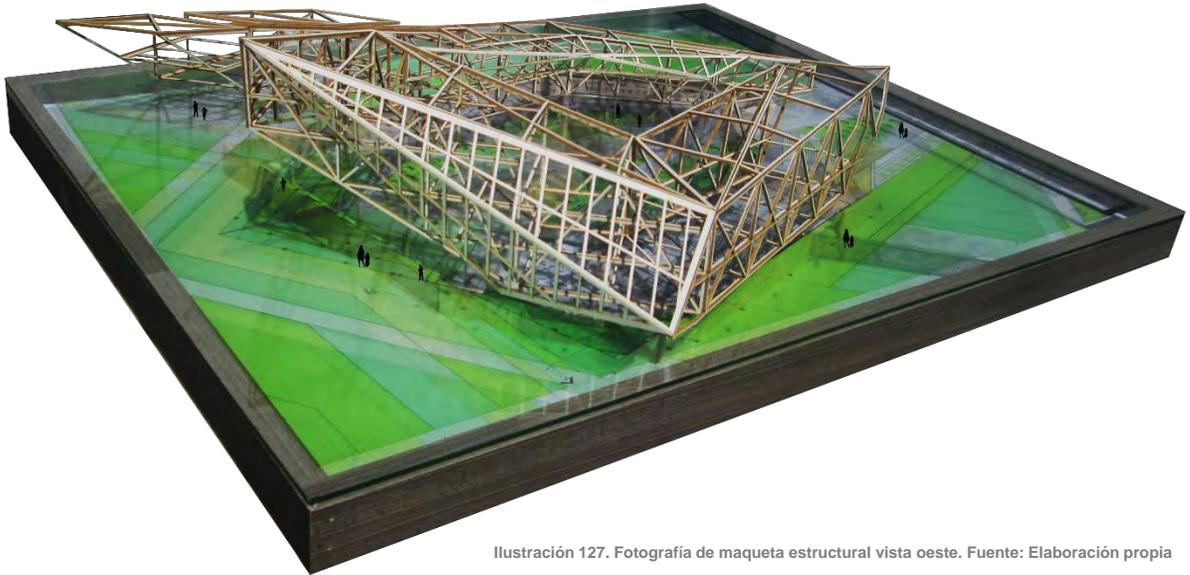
Fotografía de maqueta estructural vista oeste. Fuente: Elaboración propia
